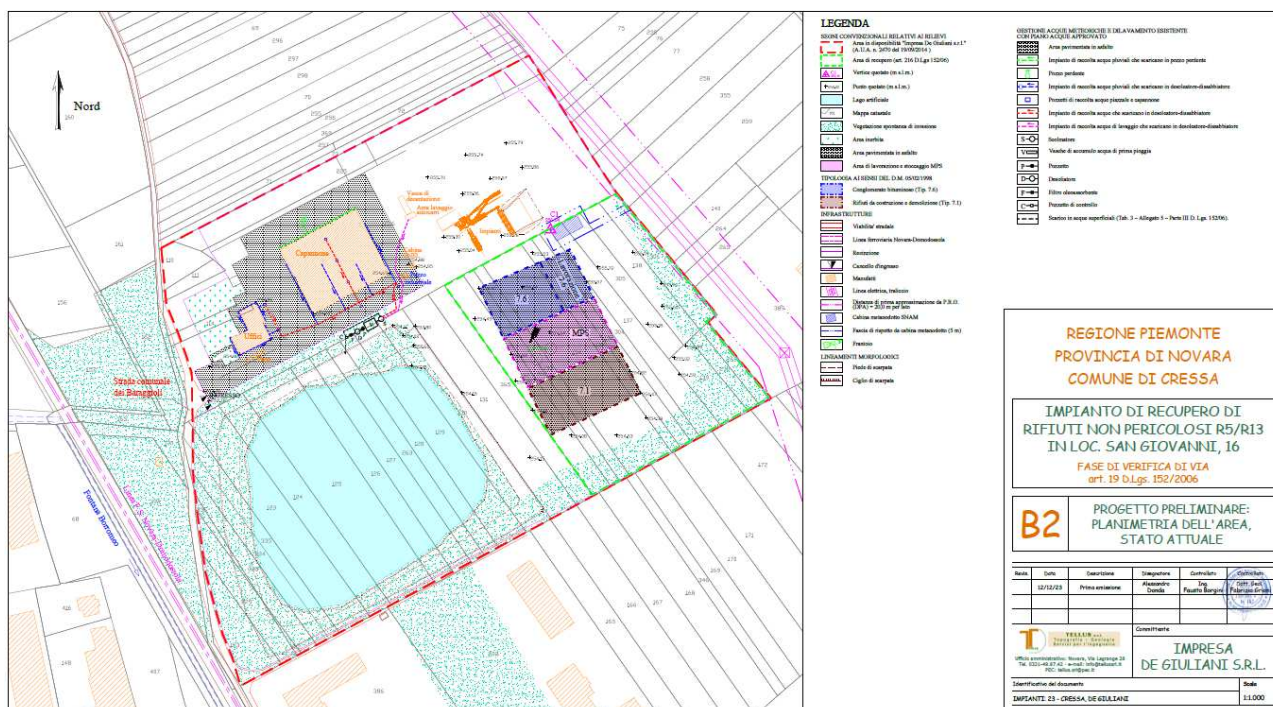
Planimetria impianto-stato attuale (tavola B2)
